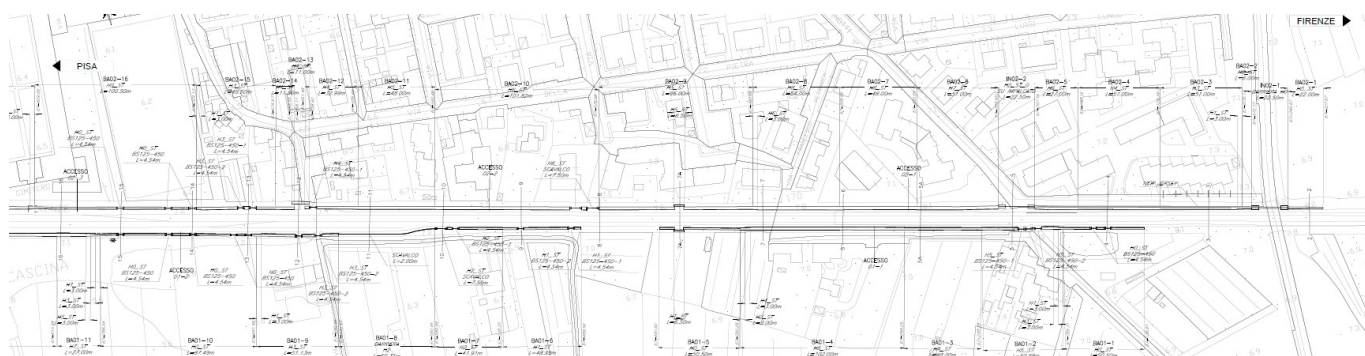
Stralcio planimetrico dell'intervento dall'inizio alla stazione di Cascina - linea "Firenze - Pisa"
